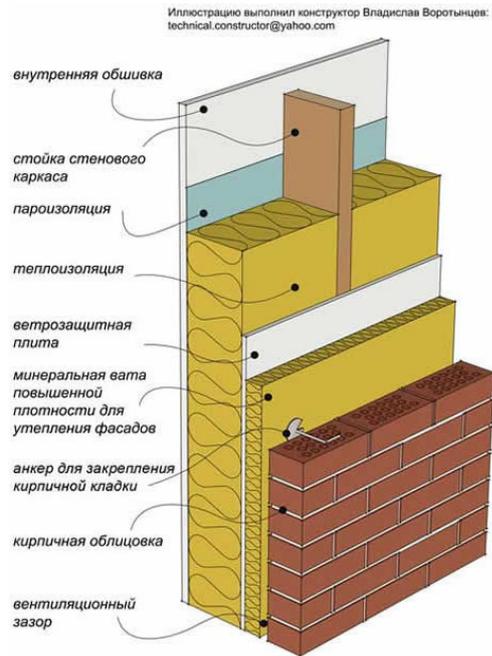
Тяжёлая наружная стена из деревянного каркаса с кирпичной наружной облицовкой
